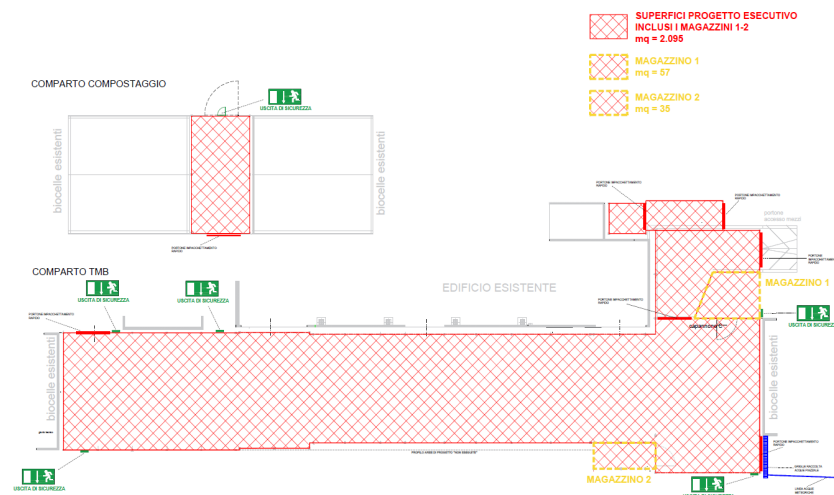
stralcio estratto da Tav.9 bis rev.00 "Lay out nuove coperture" – Progetto oggetto di modifica
